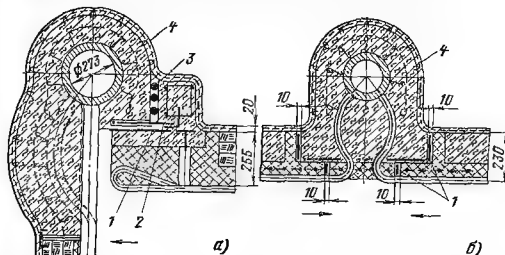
Уплотнение температурных швов в потолочном перекрытии. а — примыкание к фронтальной и боковой стене; б — промежуточный коллектор пароперегревателя; 1 — асбестовый картон; 2 — металлический лист; 3 — асбестовый шнур; 4 — газоплотная обмотка по сетке. Стрелками показано направление перемещения.
